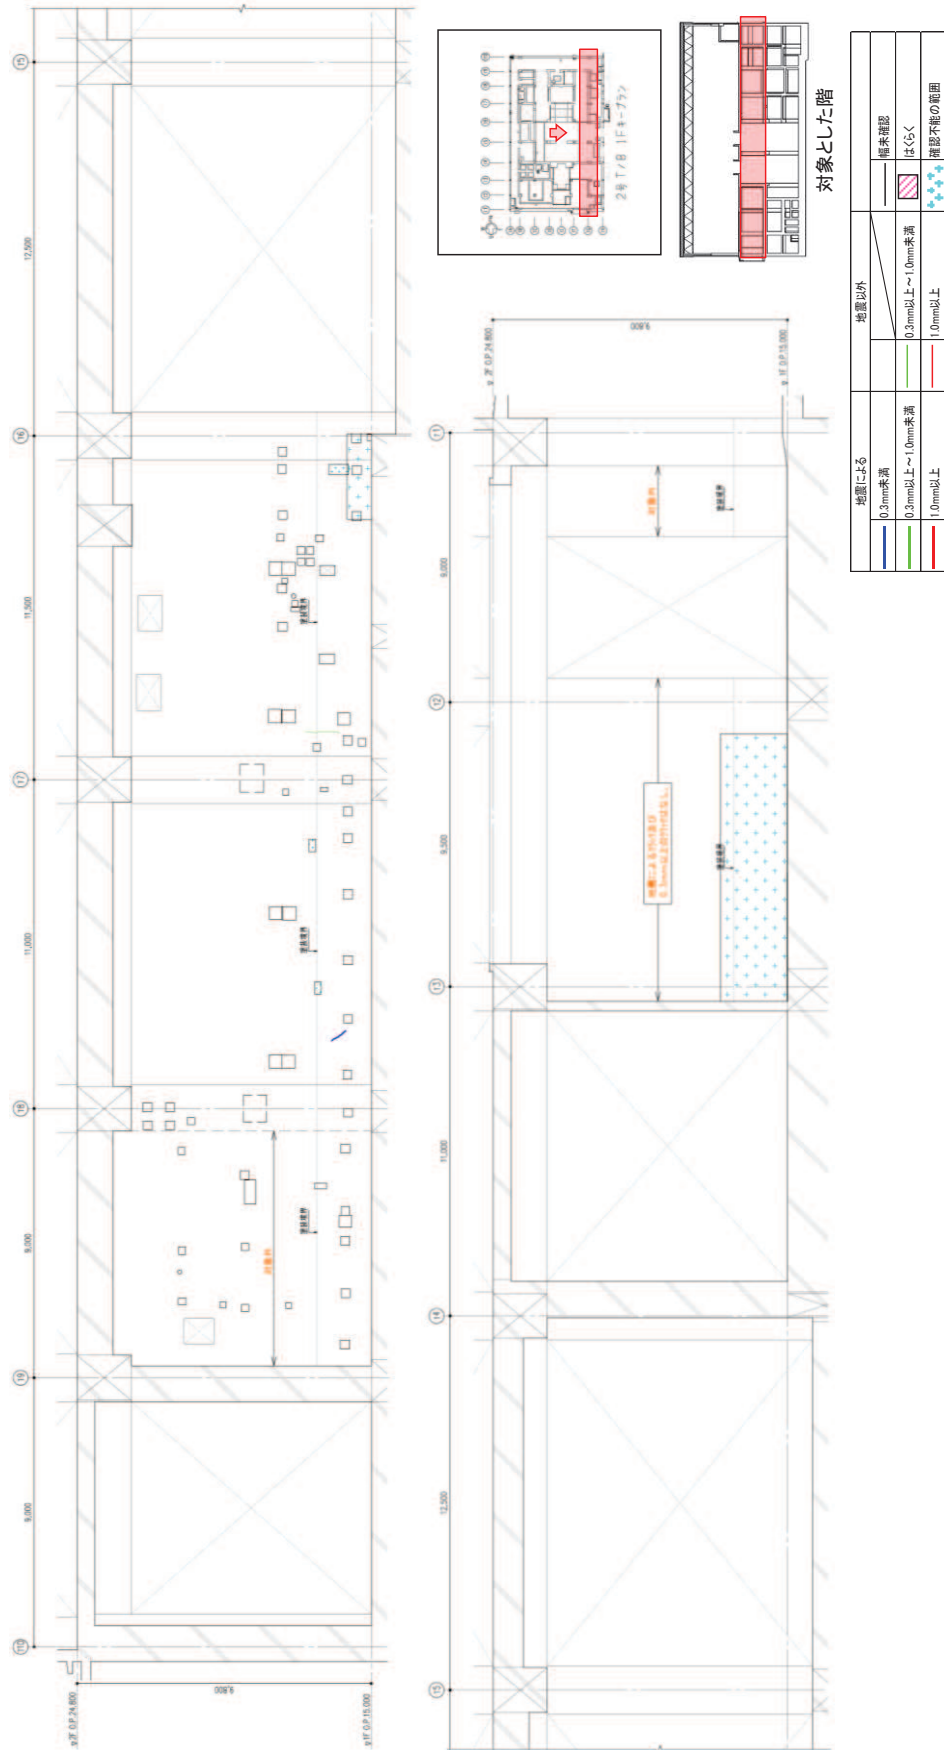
タービン建屋のひび割れ分布 耐震壁 (47) 1階 TG 通り
